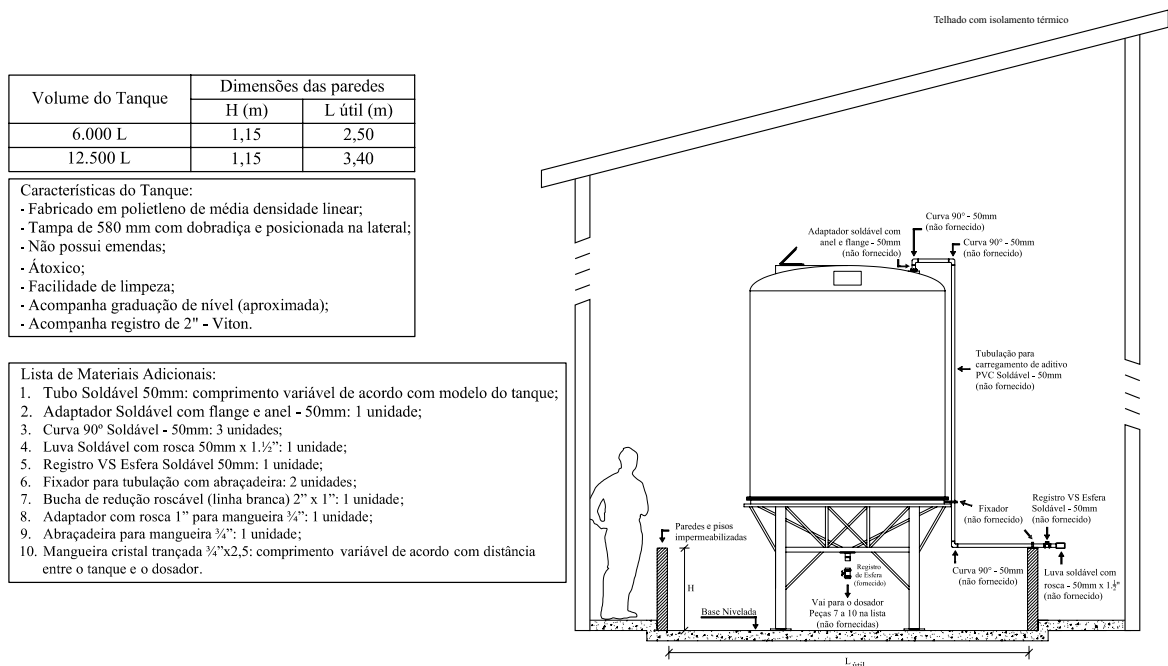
Layout de instalação de tanques para armazenamento de aditivos.
